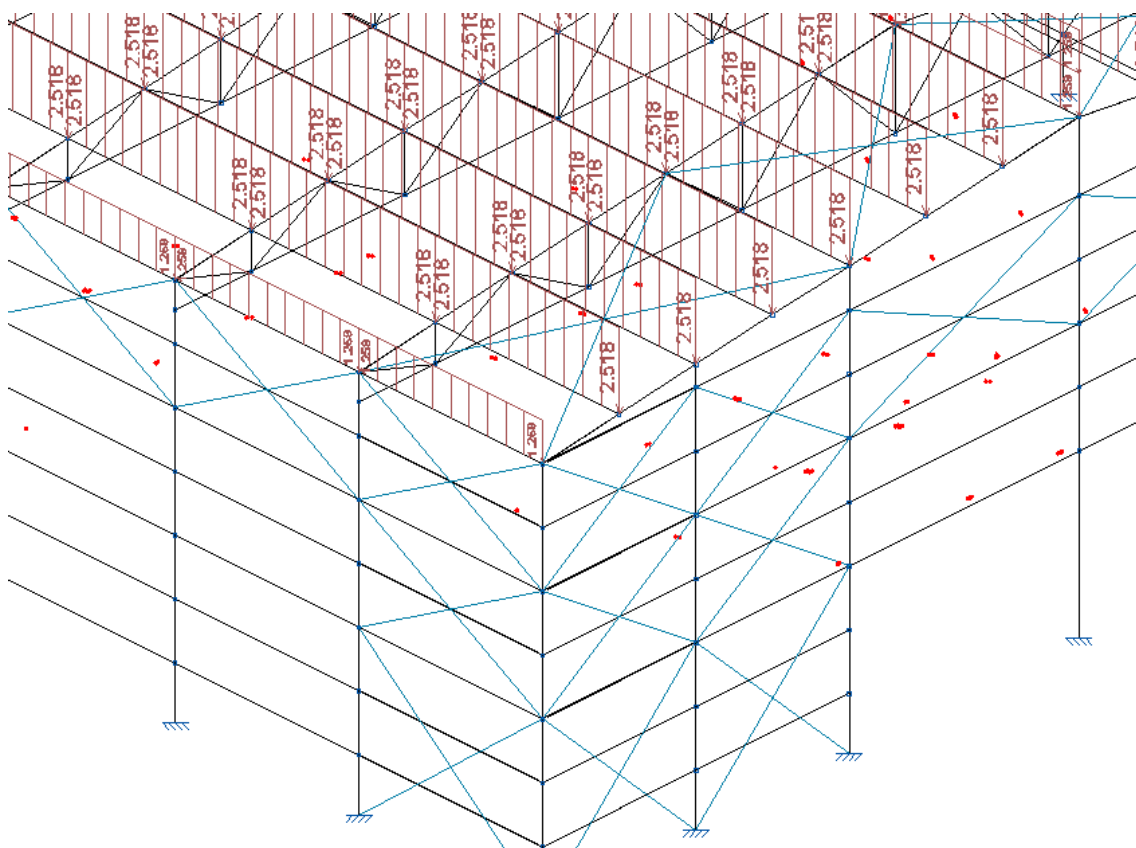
Aplicación de cargas de cerramientos de fachada lateral
